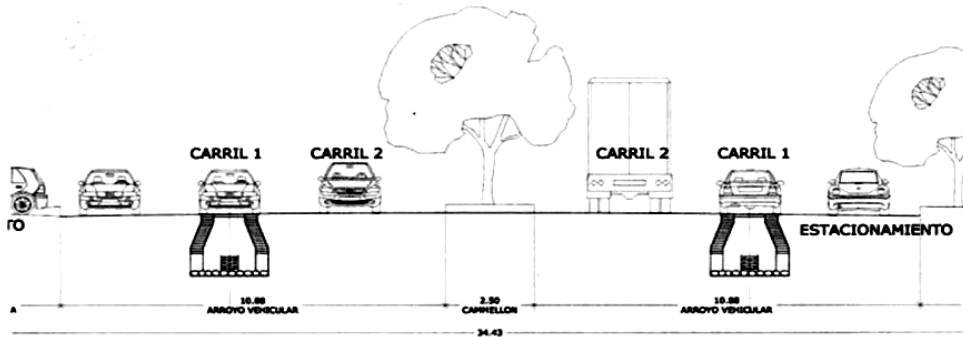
Sección de la Av. Tláhuac en su estado actual
